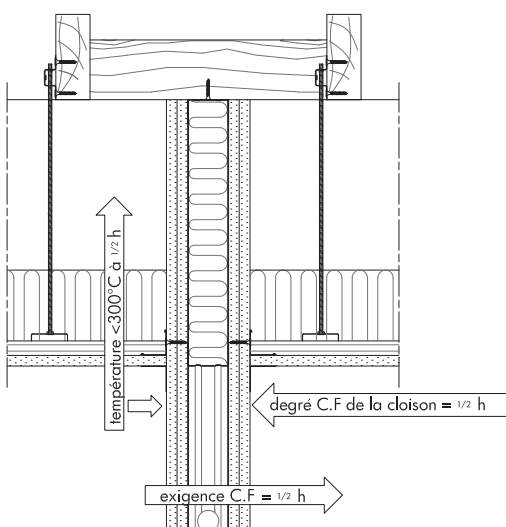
Cloisons fixées sous la structure - ERP type U
